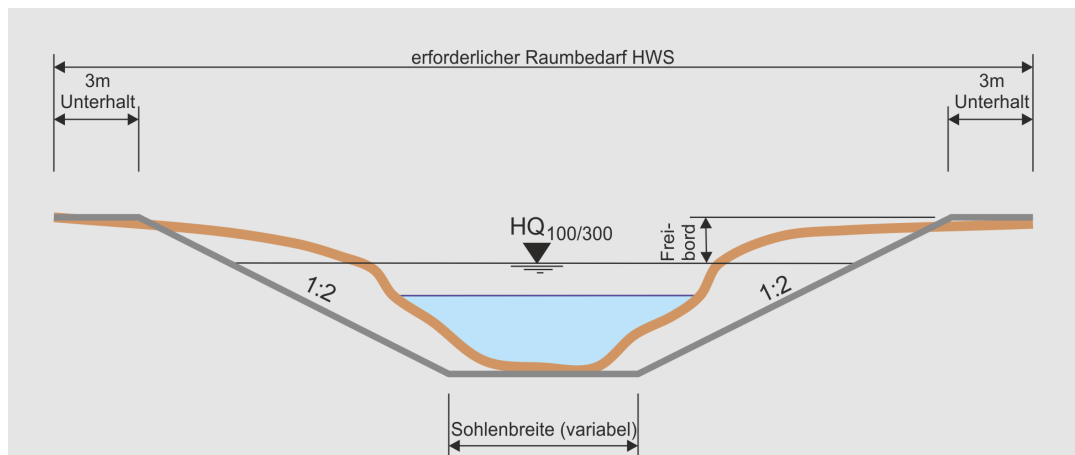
Querprofilbetrachtung für offene Fließgewässer (ohne Damm) und Eindolungen mit Öffnungspotenzial
